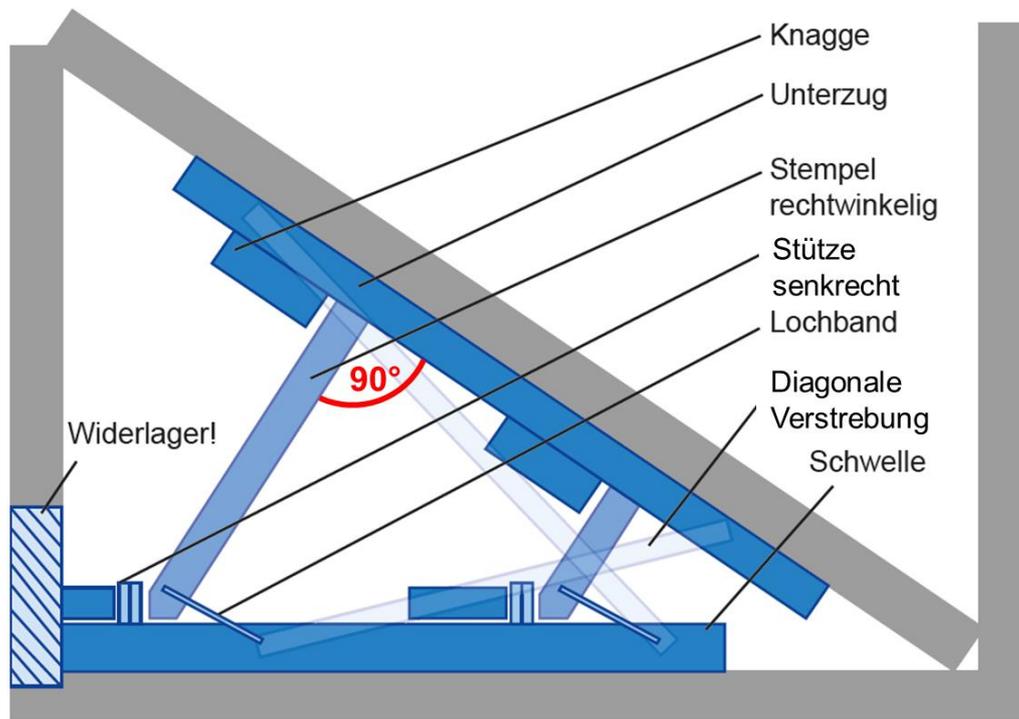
Konstruktionsprinzip schräges Flächenfachwerk aus Holz (rechtwinklige Methode)
